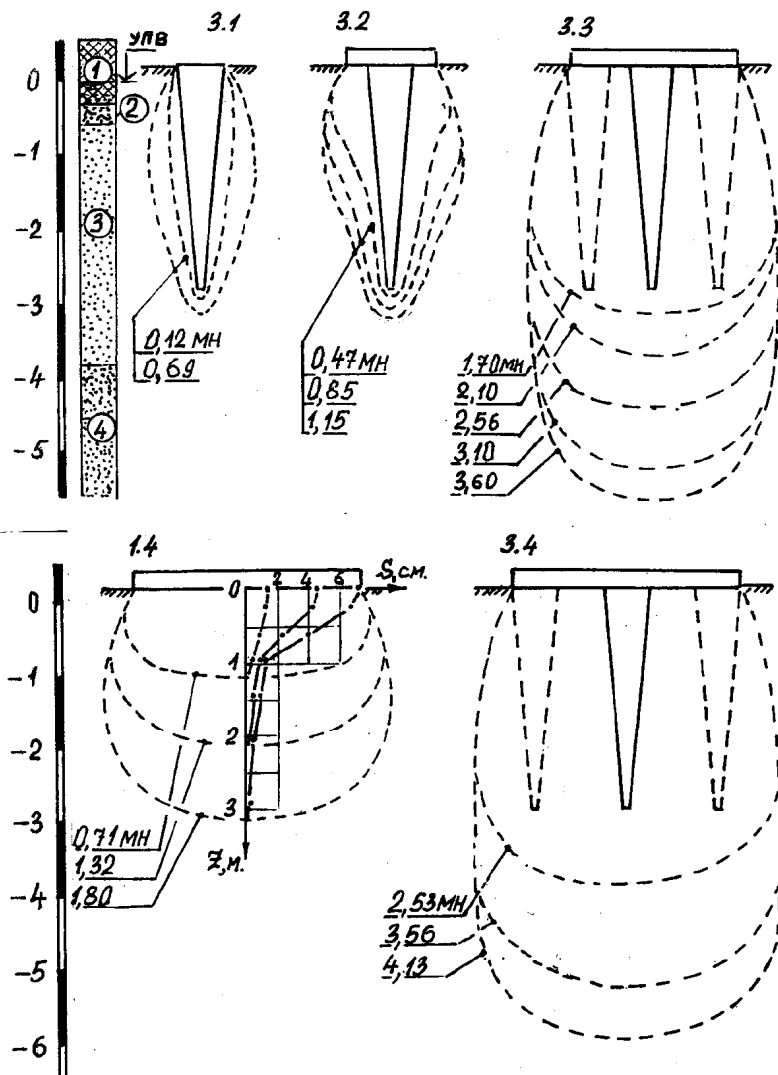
Нарастание границ зоны деформации в основаниях фундаментов свай и свайных фундаментов
